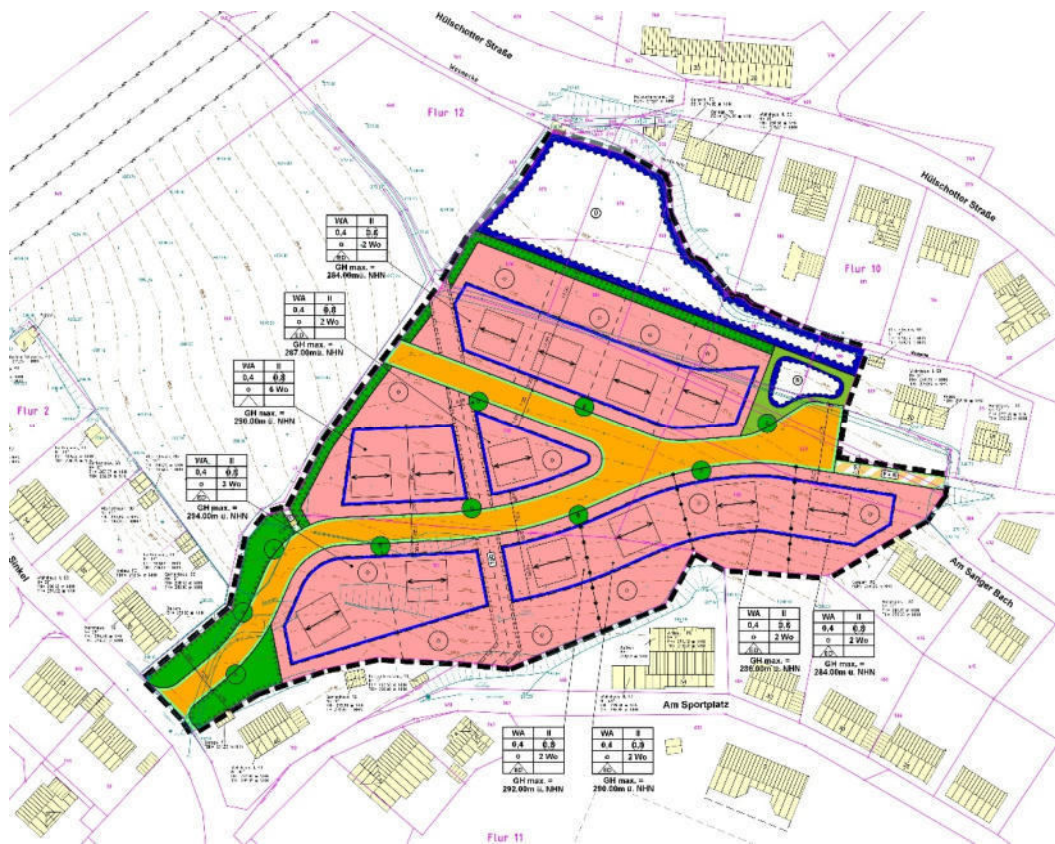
Planzeichnung zum B-Plan, Stand August 2023 (GEMEINDE FINNENTROP & FINGER BAUPLAN 2023a).
